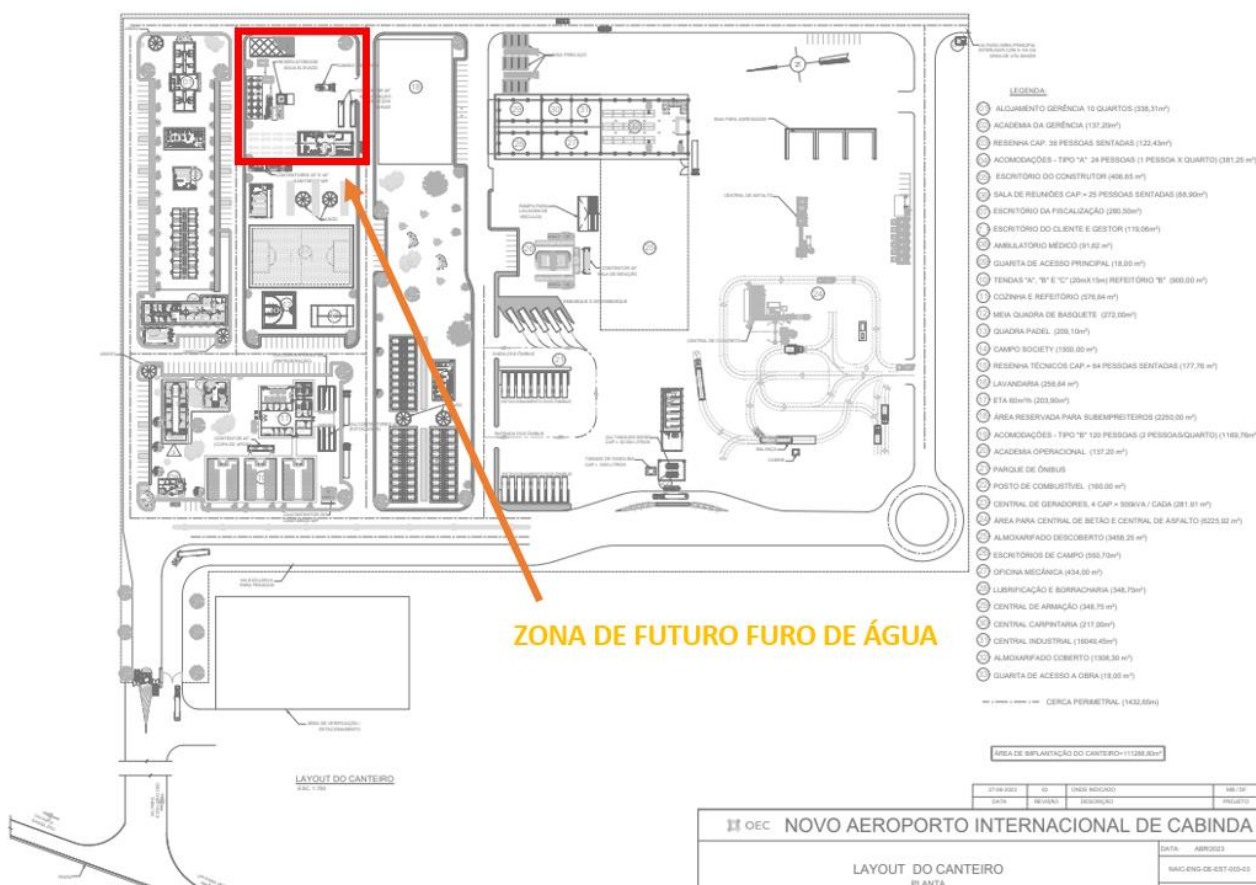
Localização do poço de água dentro da configuração do acampamento de construção do NAIC.
